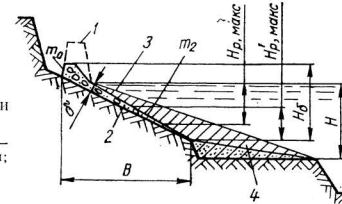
Укрепление берега банкетом из горной массы:
